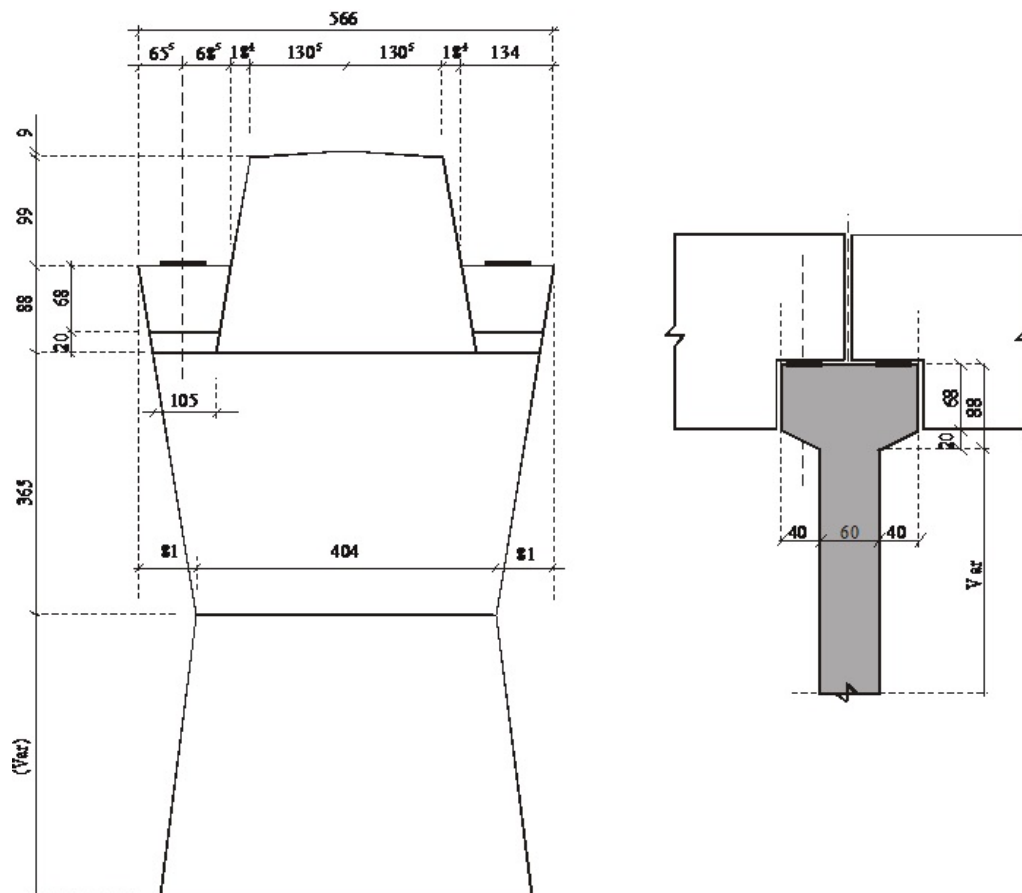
Croquis do pilar. Vista frontal e lateral (FERNANDES et al., 1999)
